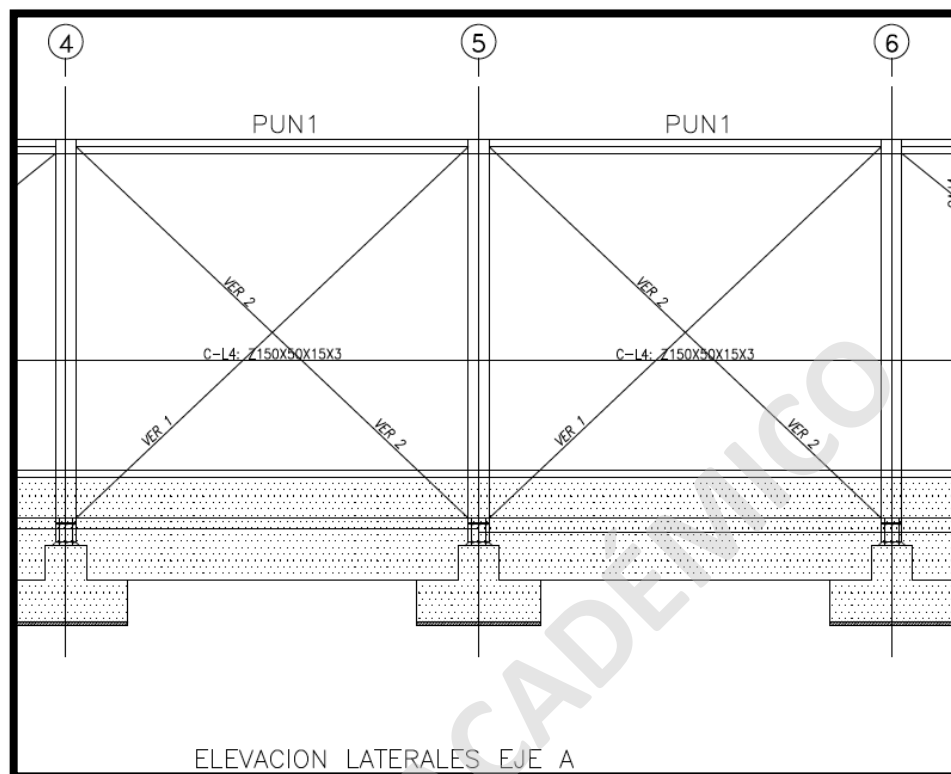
Planos de Montaje de ODR Ingeniería y Montaje
